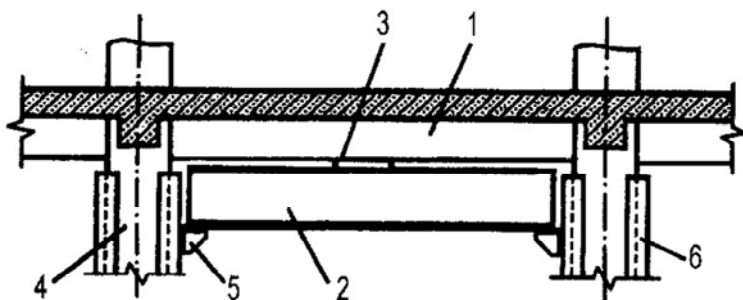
Усиление с частичным разгрузением конструкции (дополнительной упругой опорой – балкой на кронштейнах):
